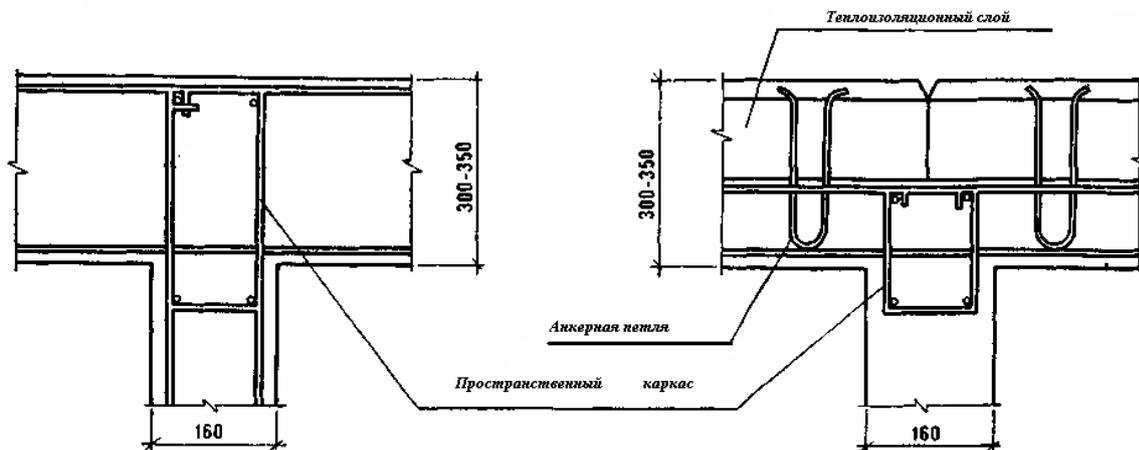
Узел армирования соединения наружной и внутренней стен: при панели наружной стены однослойной (слева), то же, слоистой (справа).
